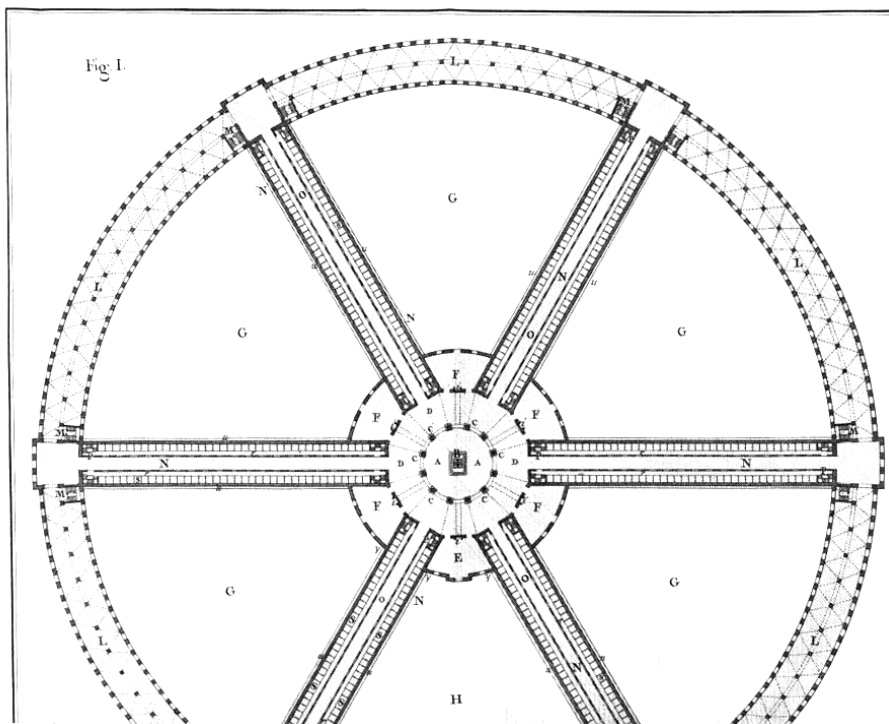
Parte de la planta del proyecto de hospital para enfermos propuesto por el cirujano Antoine Petit con la colaboración del arquitecto Prunneau de Monlouis. © Petit / BIUM.
